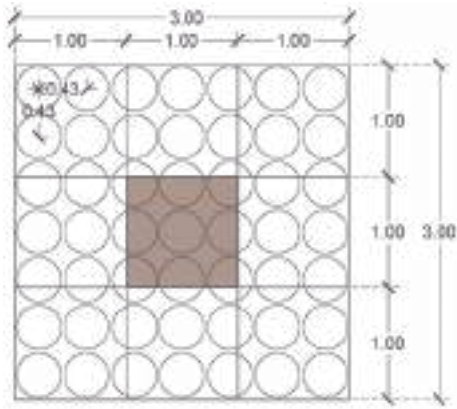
Detalle de barrera contra raíces para control en zonas pavimentadas
